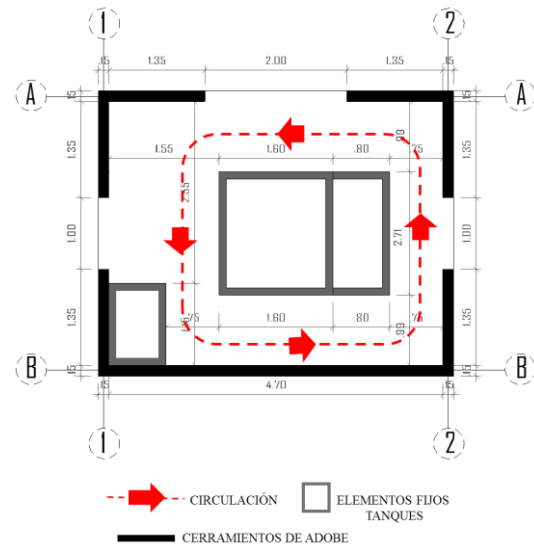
Planta de distribución típica - Tipologías 1. Fuente: propia.
